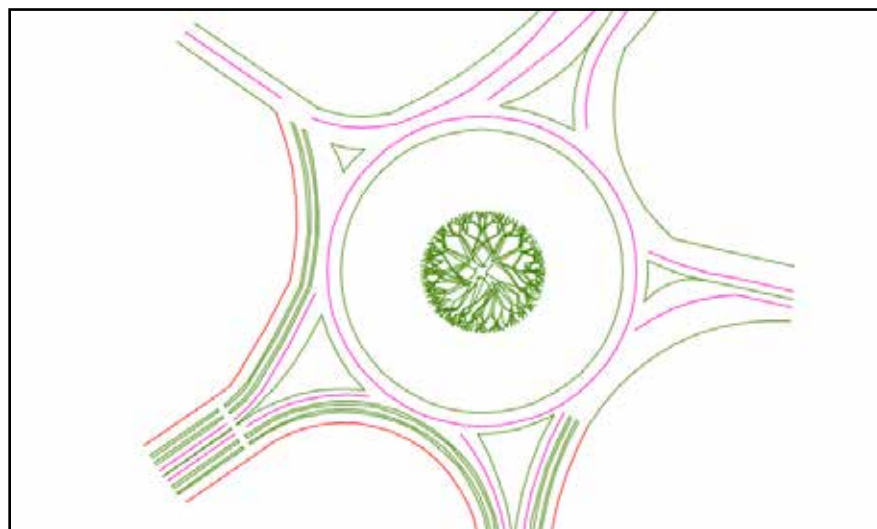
Vista en planta de la redoma planteada para el nodo empresarial.
